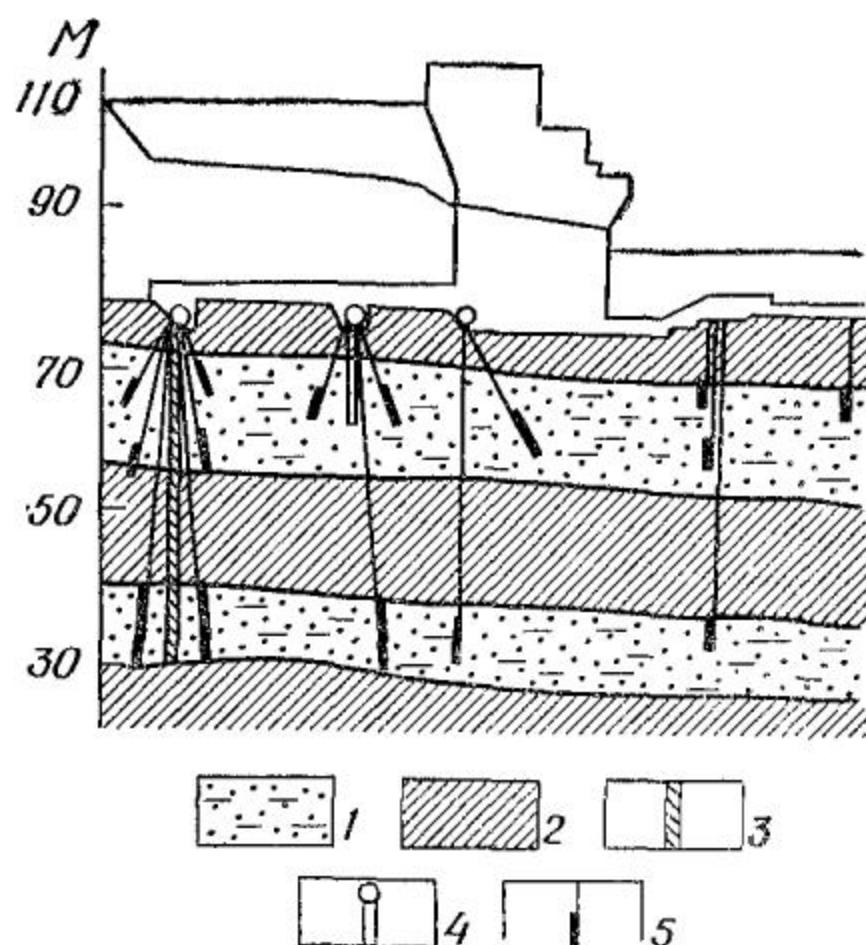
Схема размещения скважин-пьезометров в основании бетонной плотины Камской ГЭС
